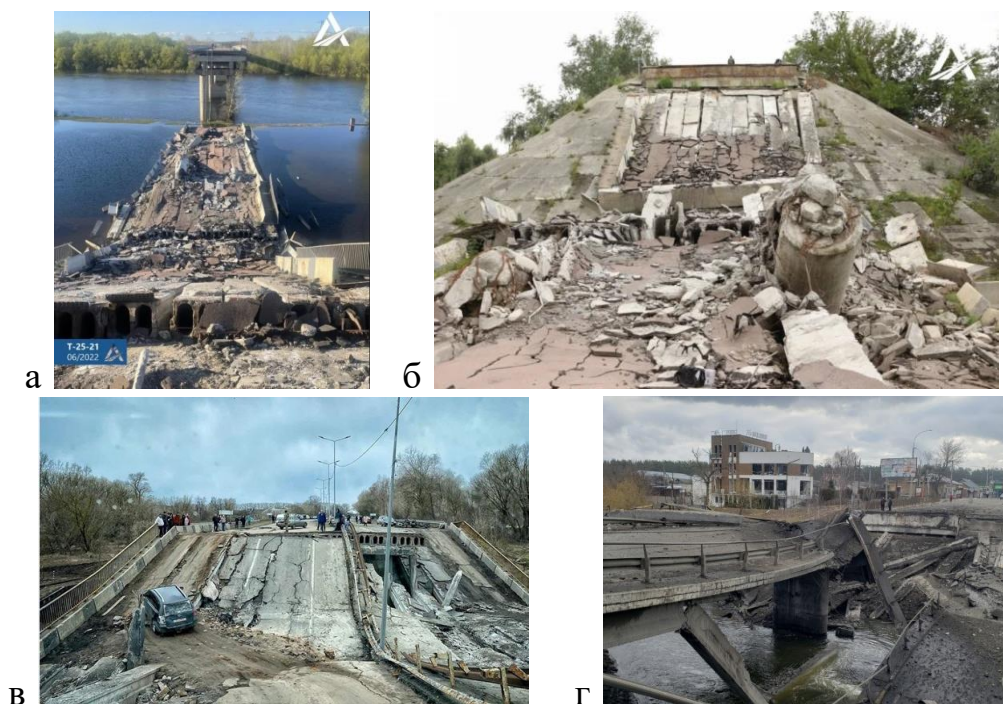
Зруйновані залізобетонні мости (а-г) [1-3]
